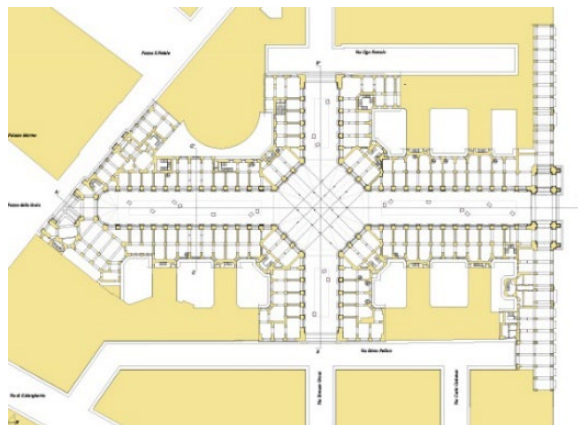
Planimetria della Galleria Vittorio Emanuele
